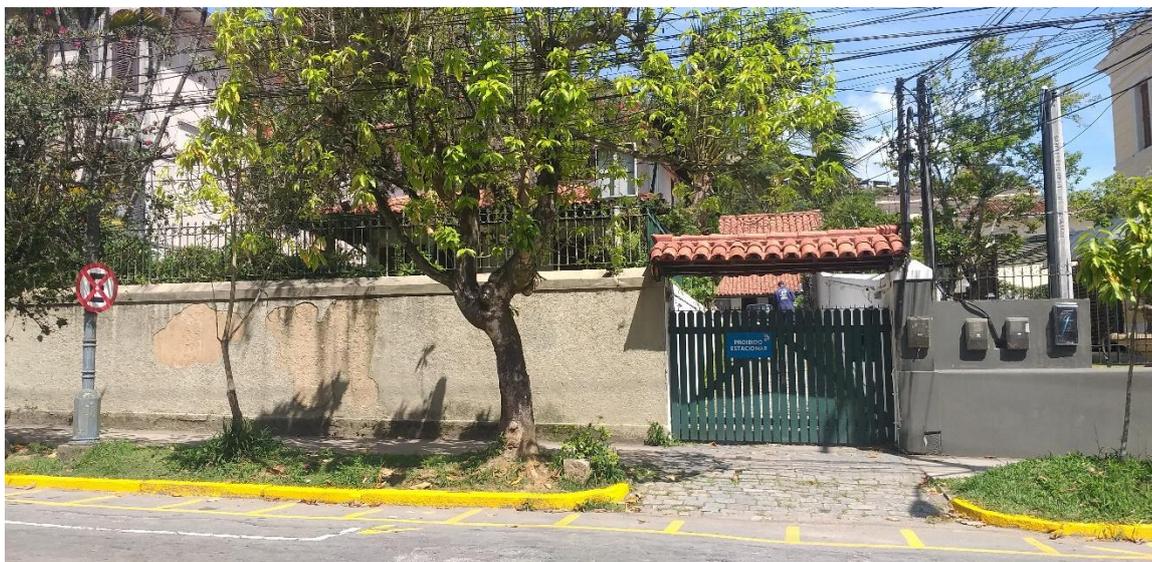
MURO E PORTÃO – ACESSO AO LOTE
